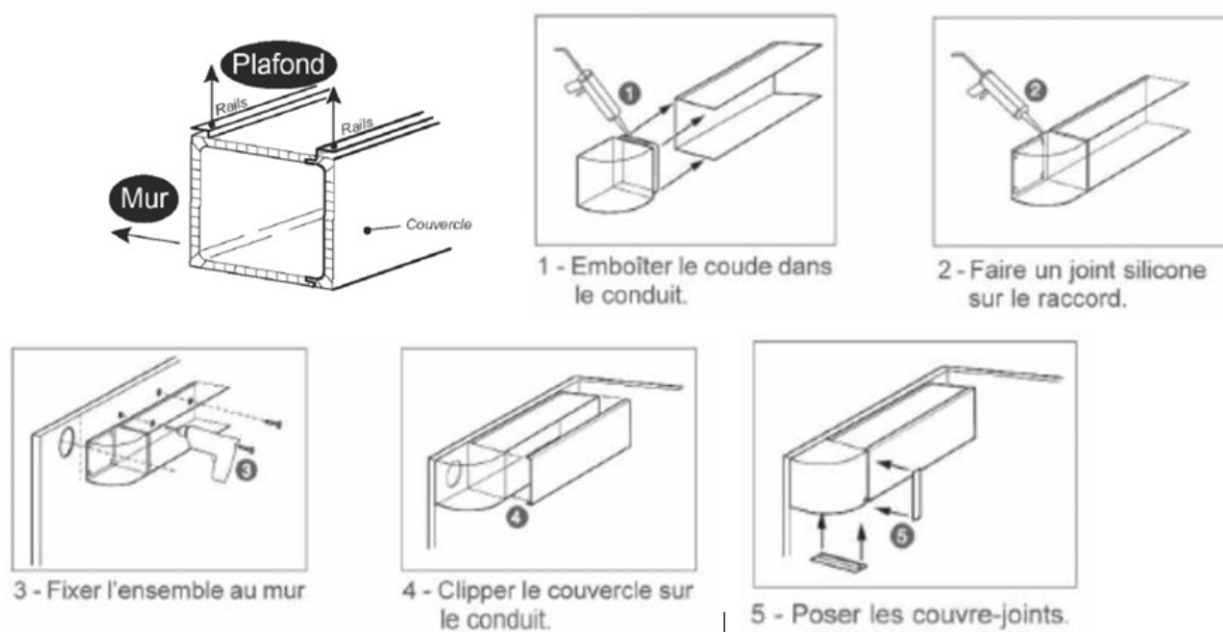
Exemples de mise en œuvre des conduits horizontaux T2a
